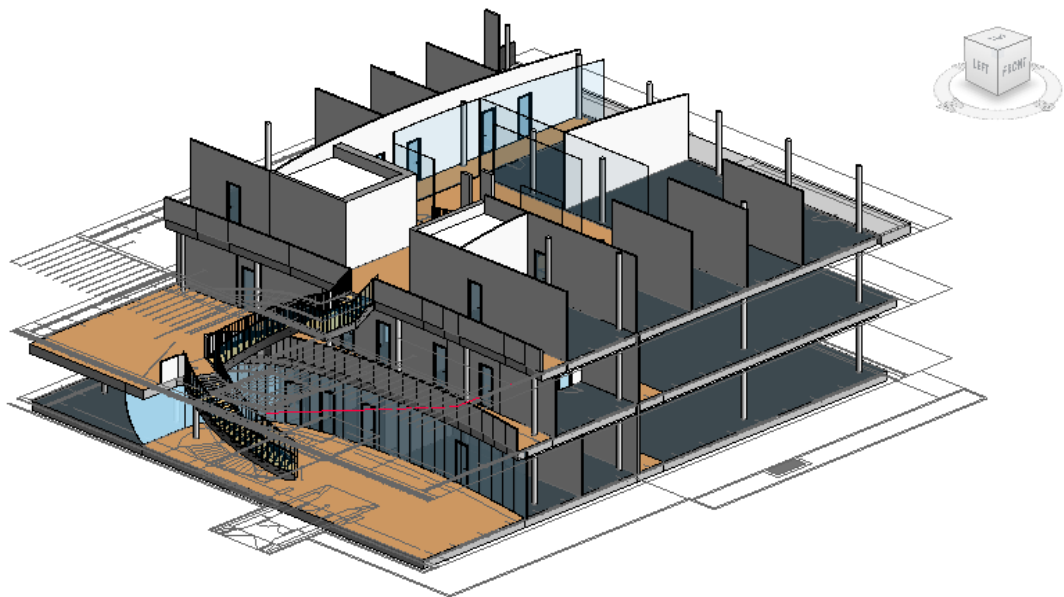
7 Prospetto nord-est dell'edificio modellato in Revit
